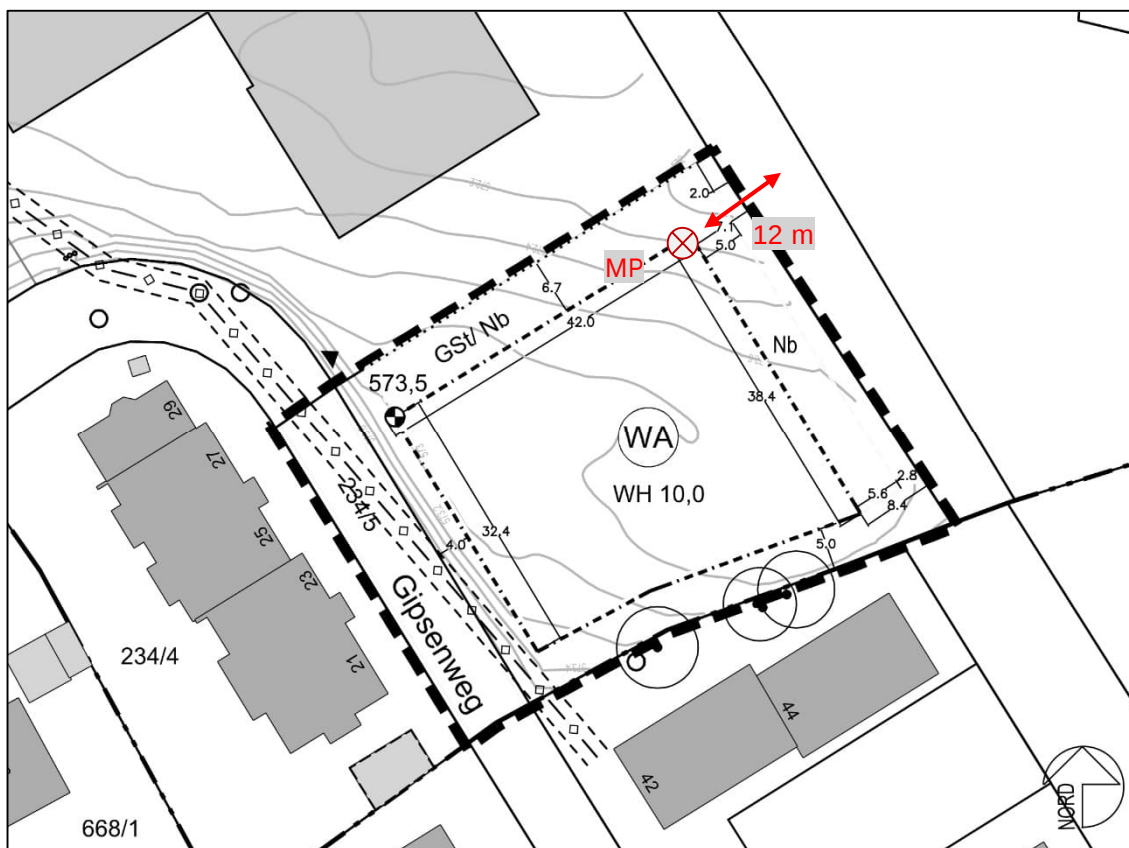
Lageplan /14/ mit Kennzeichnung des Messpunktes MP
